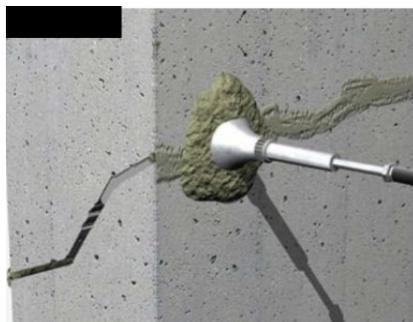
Se muestra fisura reparada con método de inyección de fisuras con resina epoxi.
